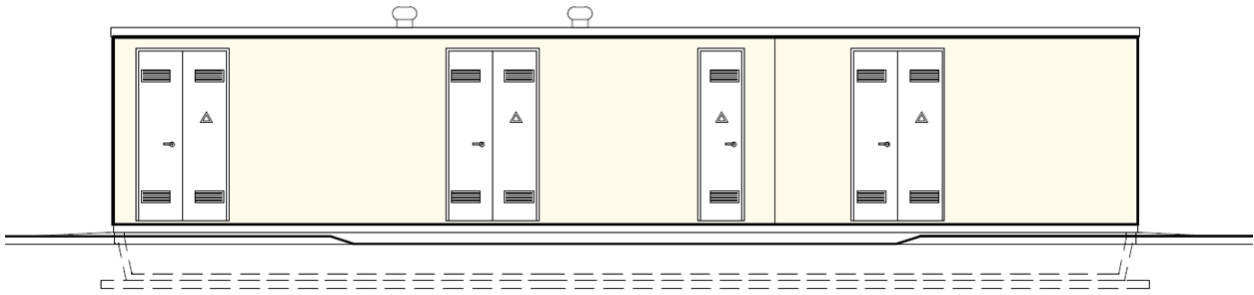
Prospetto frontale della cabina MT/BT in progetto
